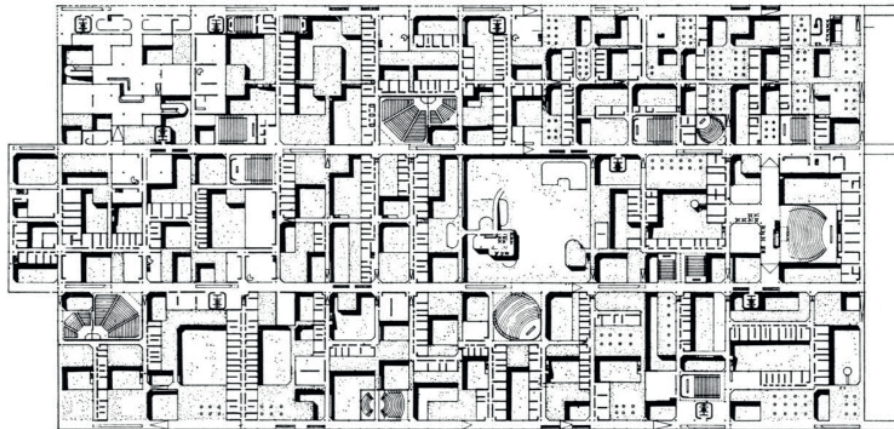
Candilis-Josic-Woods. (1963) planta de la Universidad de Berlín.
